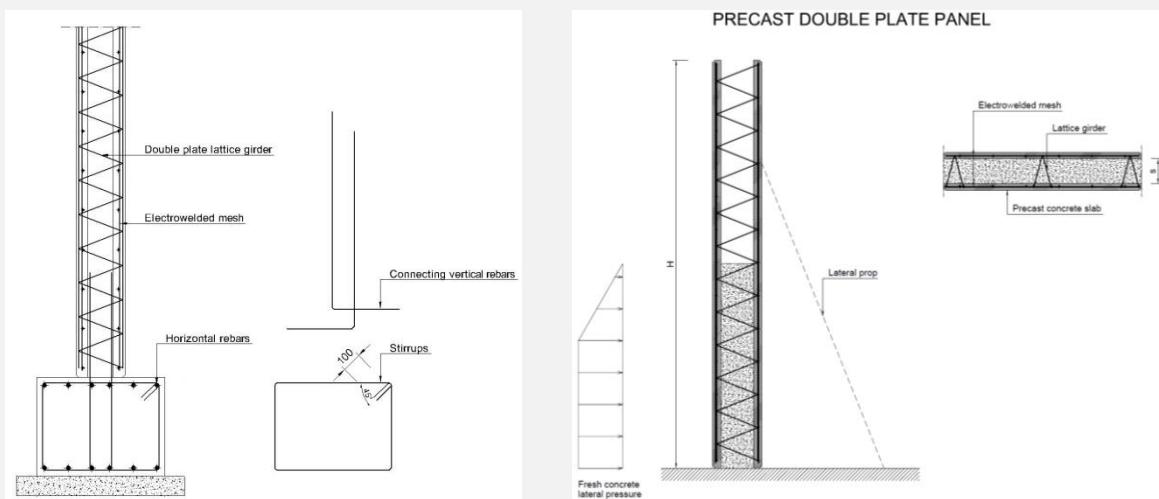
Detaliu structural tipic de prindere a pereților din b.a. de fundație (secțiune verticală).
